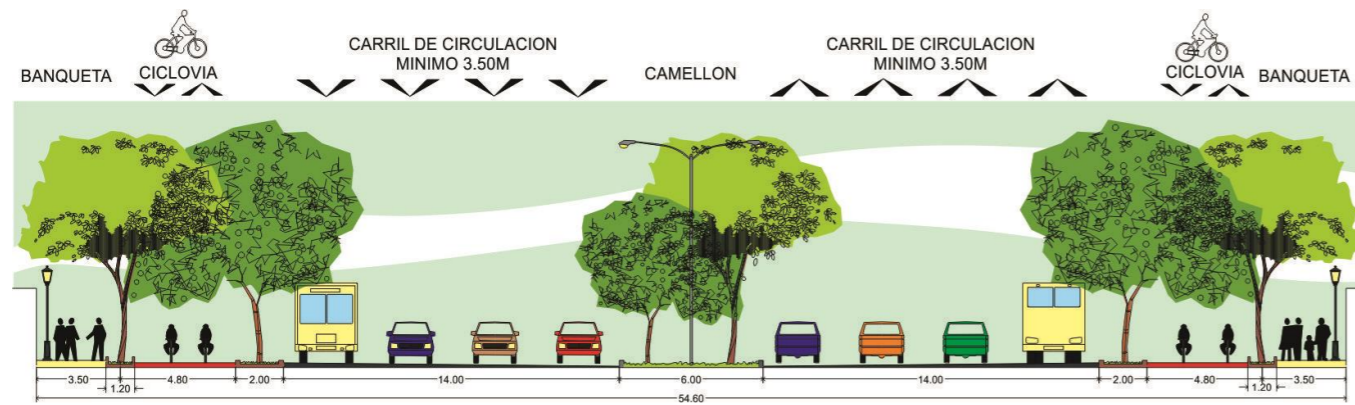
Corte Vialidad Primaria en el Proyecto. Fuente: Archivo Propio
